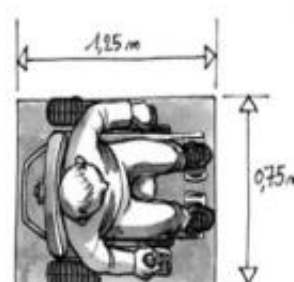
DIMENSION D'UN FAUTEUIL
